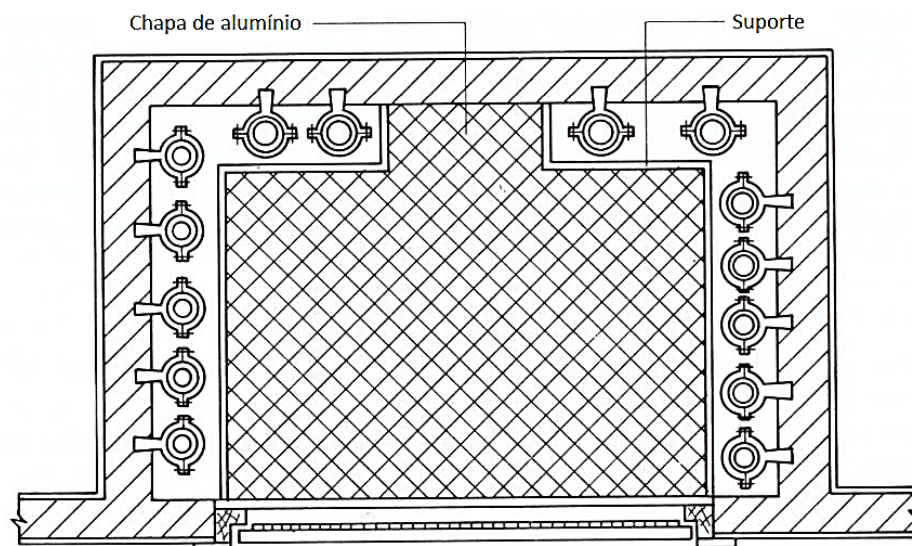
Coluna vertical totalmente acessível (em planta). [5]
